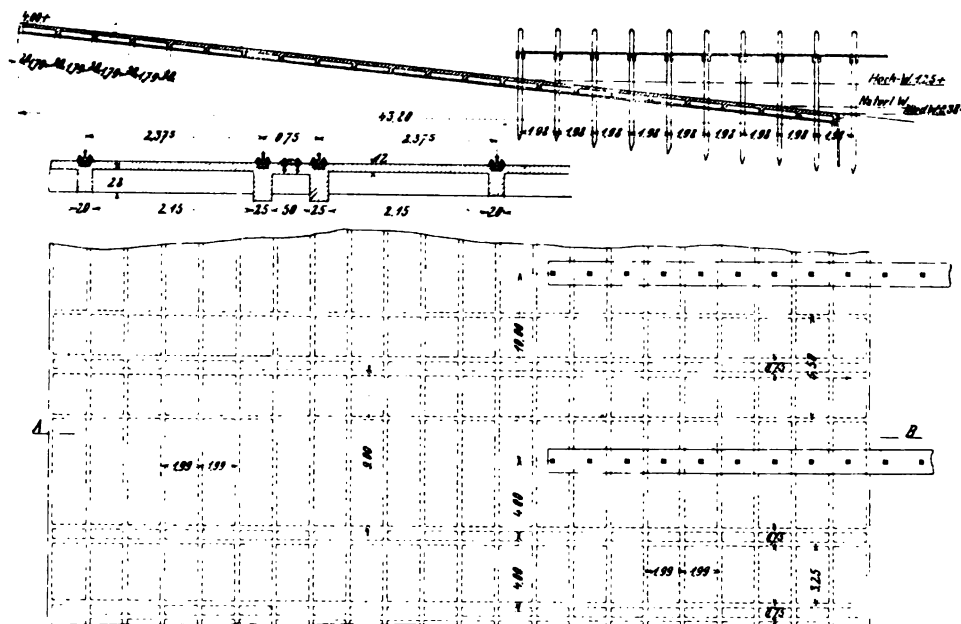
Helling im Hafen von Scheveningen, Längsschnitt durch einen Längshelling, Querschnitt und Grundriß desselben nebst einem Stück des Querhellinges.
